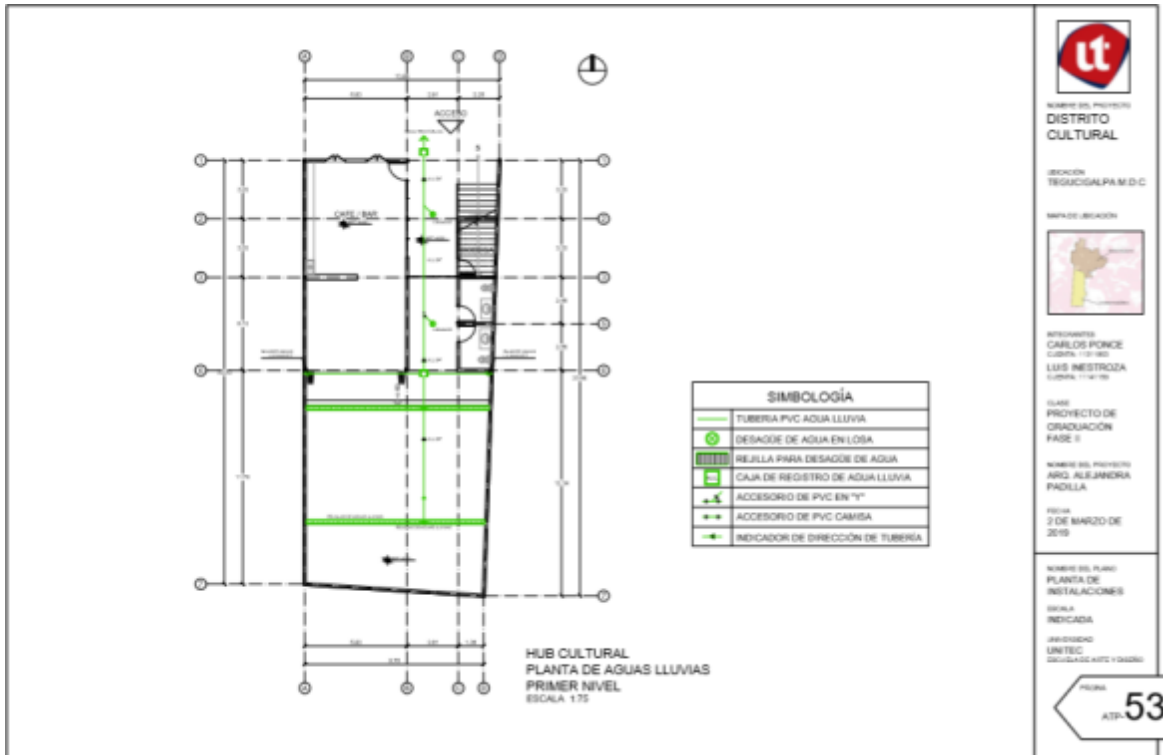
Planta de Aguas Lluvias Hub Cultural
